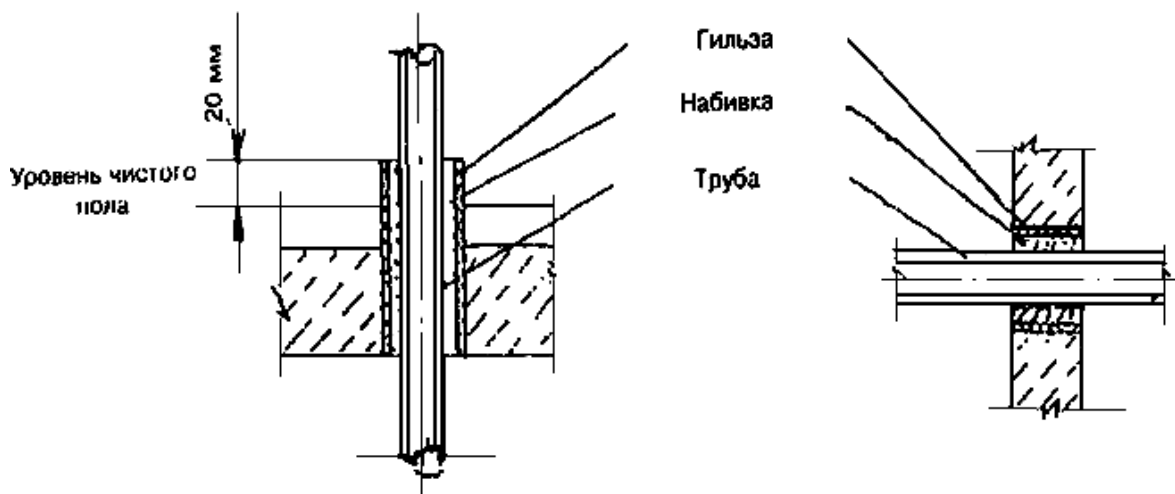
Установка гильзы для прокладки труб в стенах и перекрытиях
